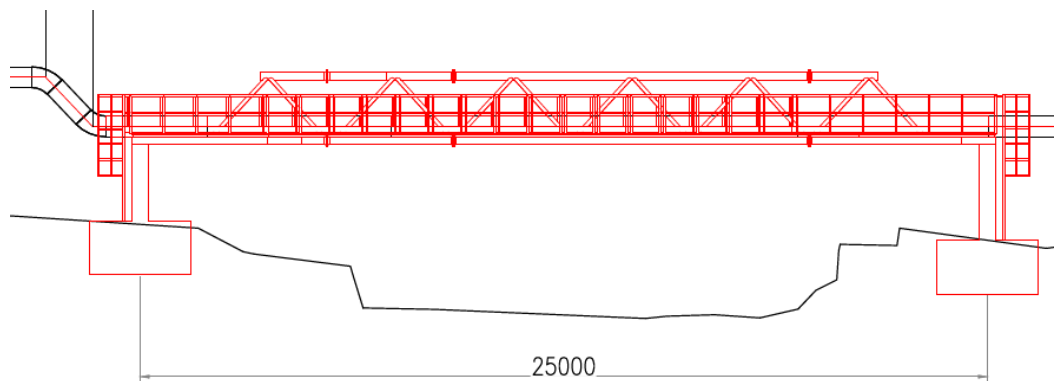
Attraversamento A2 sul torrente Rimaggio (TC8892) – Vista in sezione
